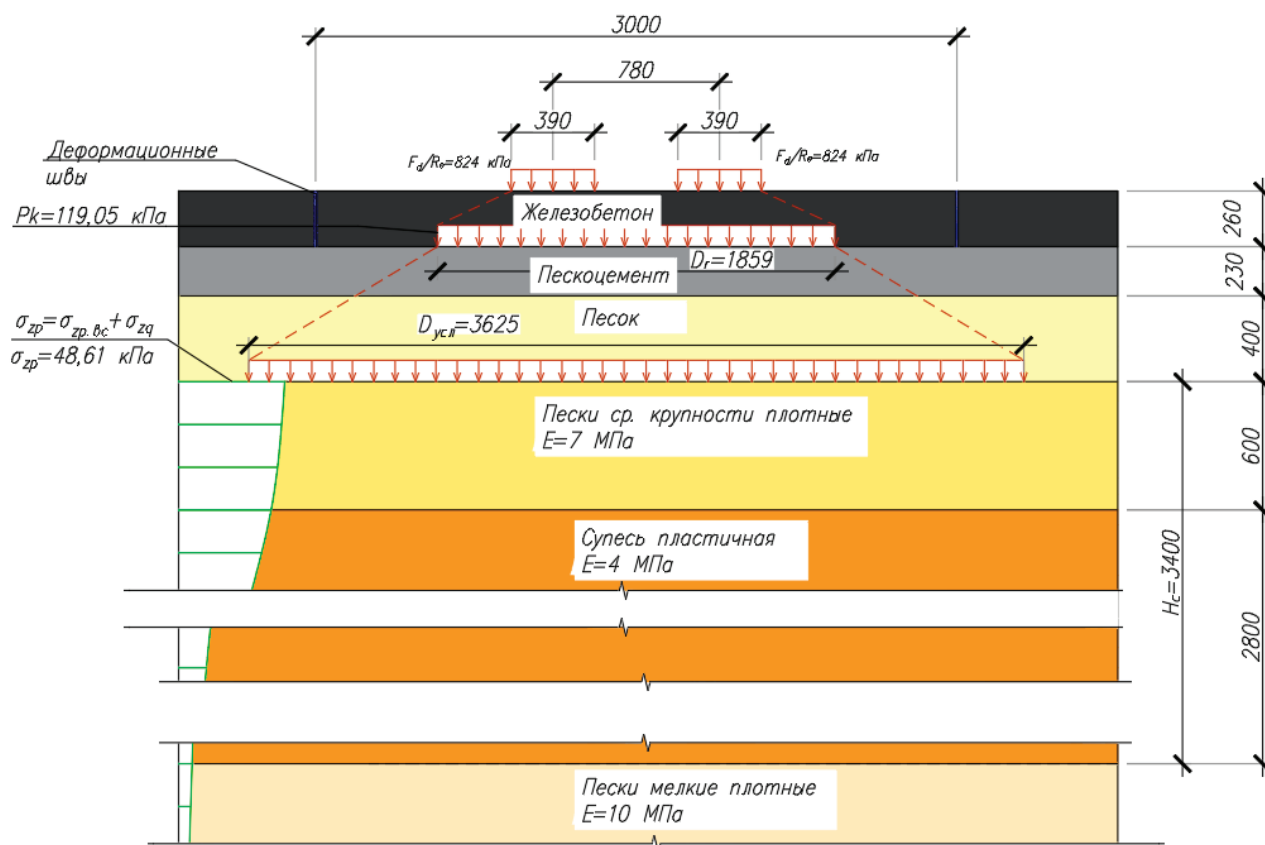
Расчетная схема к расчетам осадок оснований аэродромных покрытий
